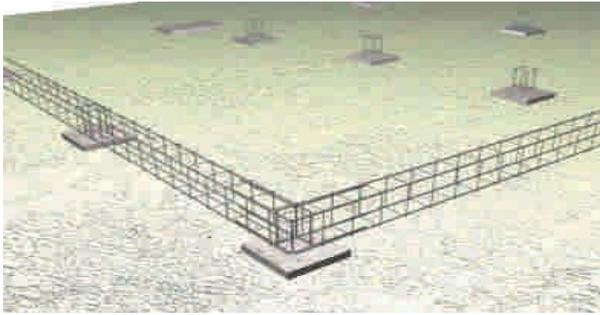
4: Fundación continua, pilotes de hormigón con viga de fundación.
